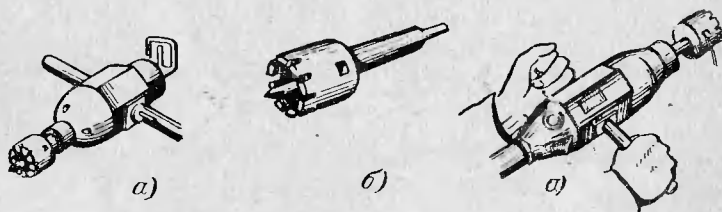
Сверление гнезд под выключатели или штепсельные розетки в кирпиче.
